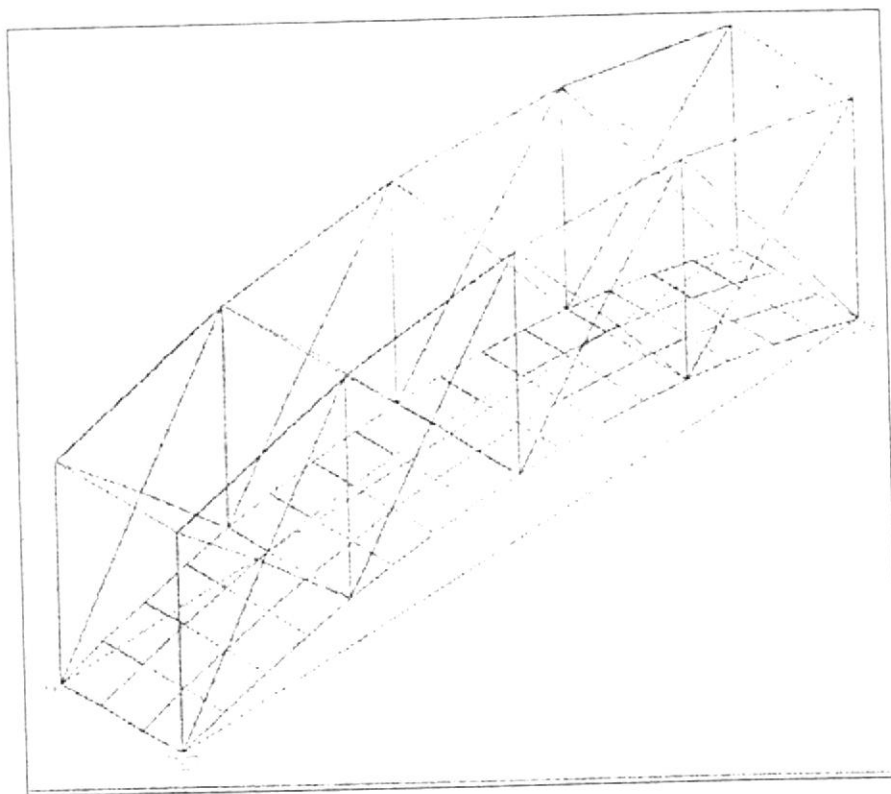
Restricciones y apoyos en el puente de 10m.
